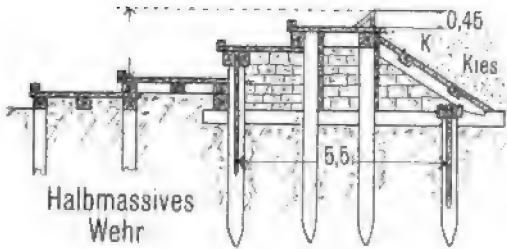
Festes Schwarzwaldwehr alter Bauweise: Stufenwehr.
